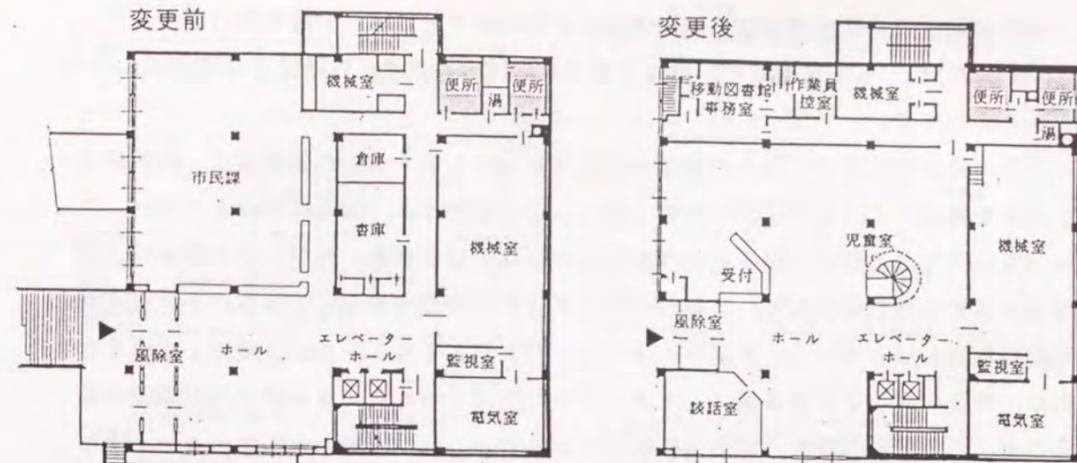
<10>狭山市立図書館(旧市庁舎)1階平面図
